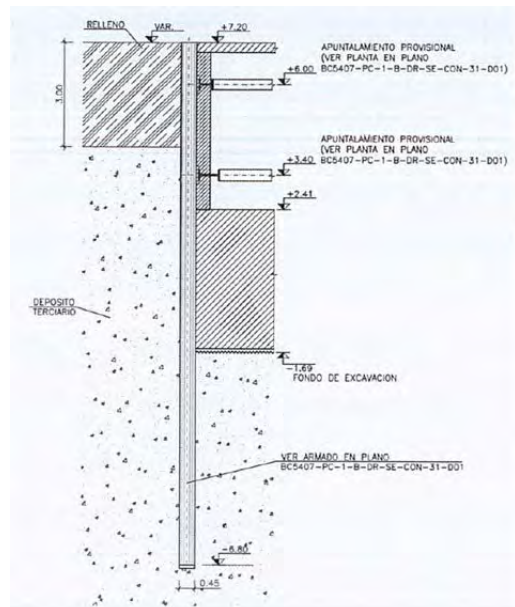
Esquema en alzado de los principales elementos de apuntalamiento para la Torre B.
